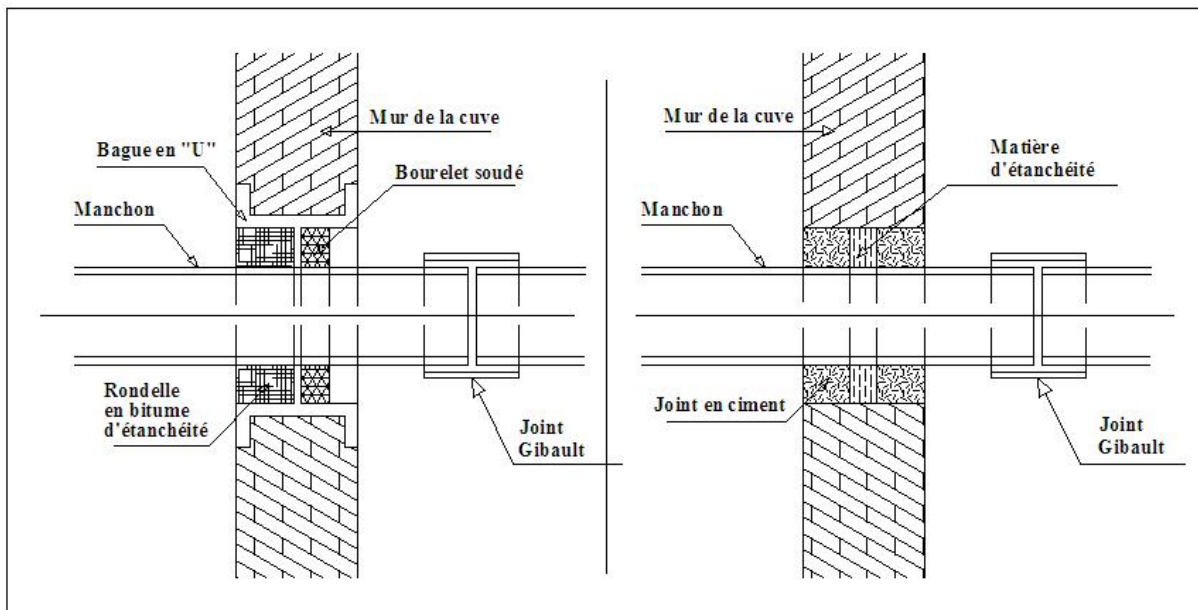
Traversée des conduites (manchon à bout lisse)
